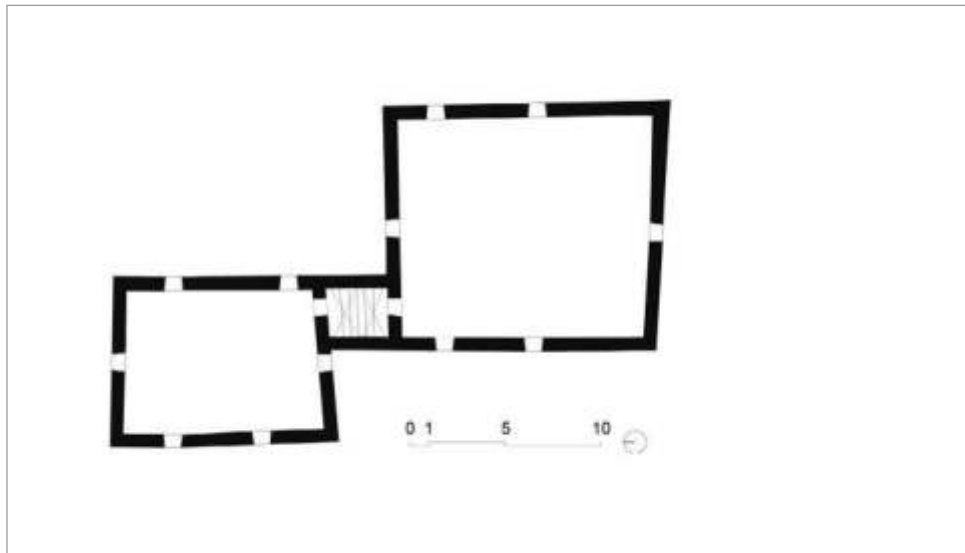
Grundriss Schrofenstein, erstes Obergeschoss. Gezeichnet von Arch. Achim Reese
